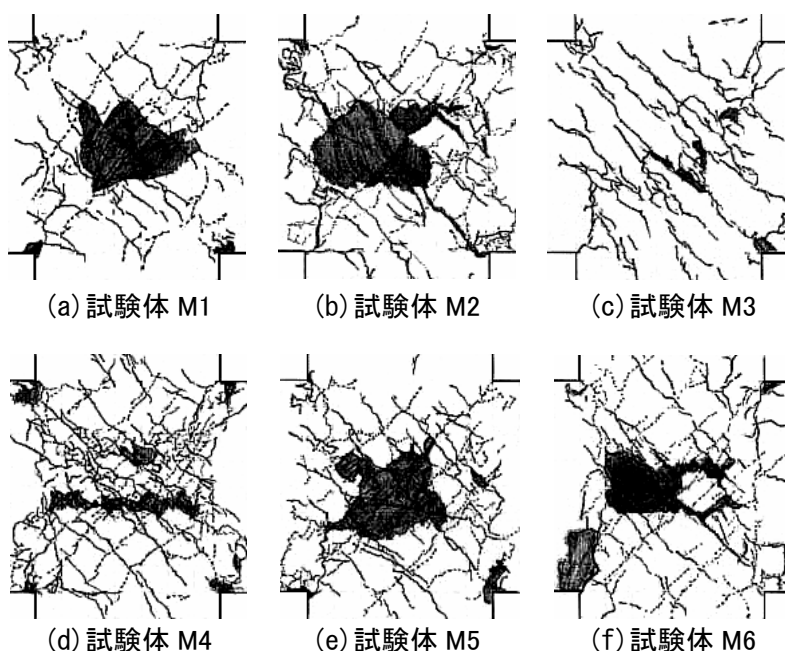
ひび割れ状況 (層間変形 $\theta=1/25rad.$)
